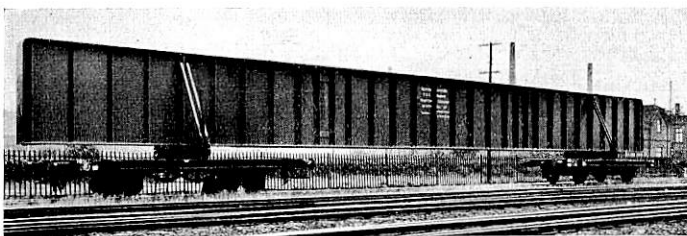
Geschweißter Hauptträger mit durch Laschen verstärkten Stumpfstoßen.
